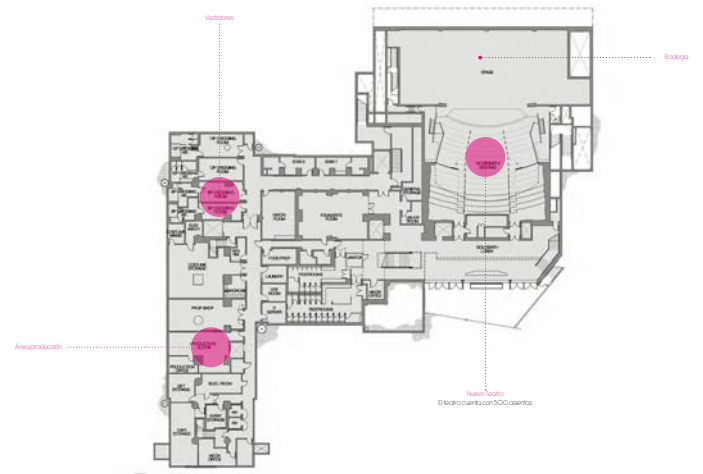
Planta baja: Recuperado y editado de archdaily.com
